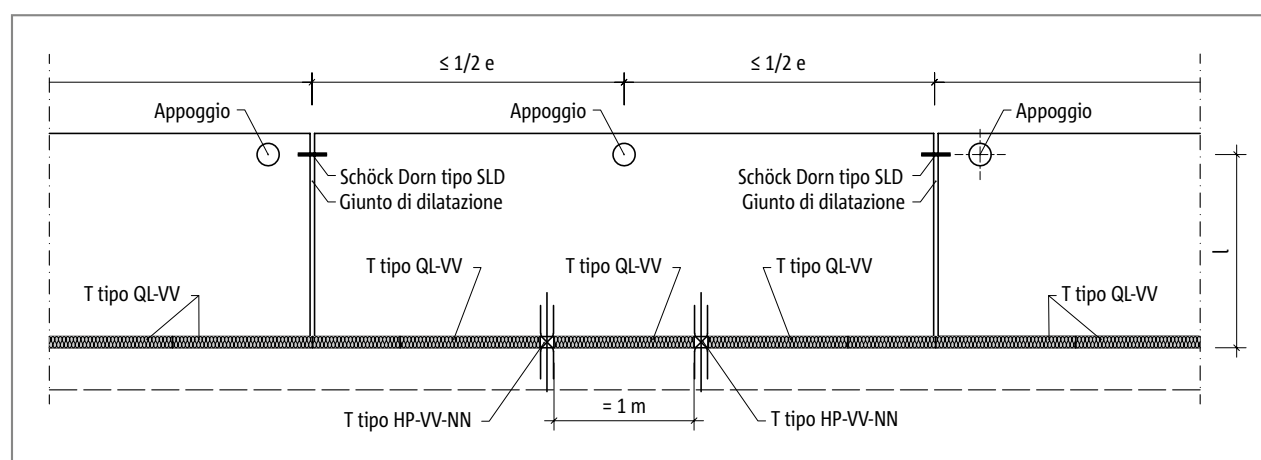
Schöck Isokorb® T tipo HP: disposizione dei giunti di dilatazione
